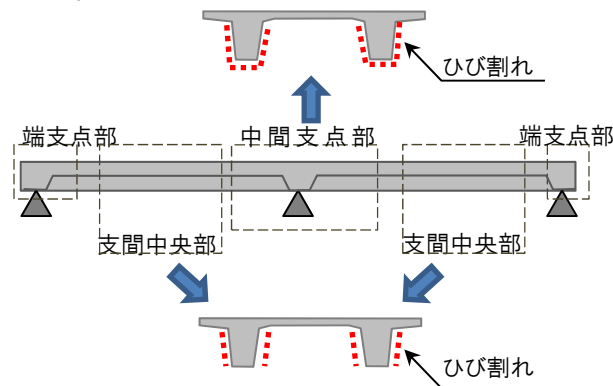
過去の二主版桁橋のひび割れ発生状況の模式図
